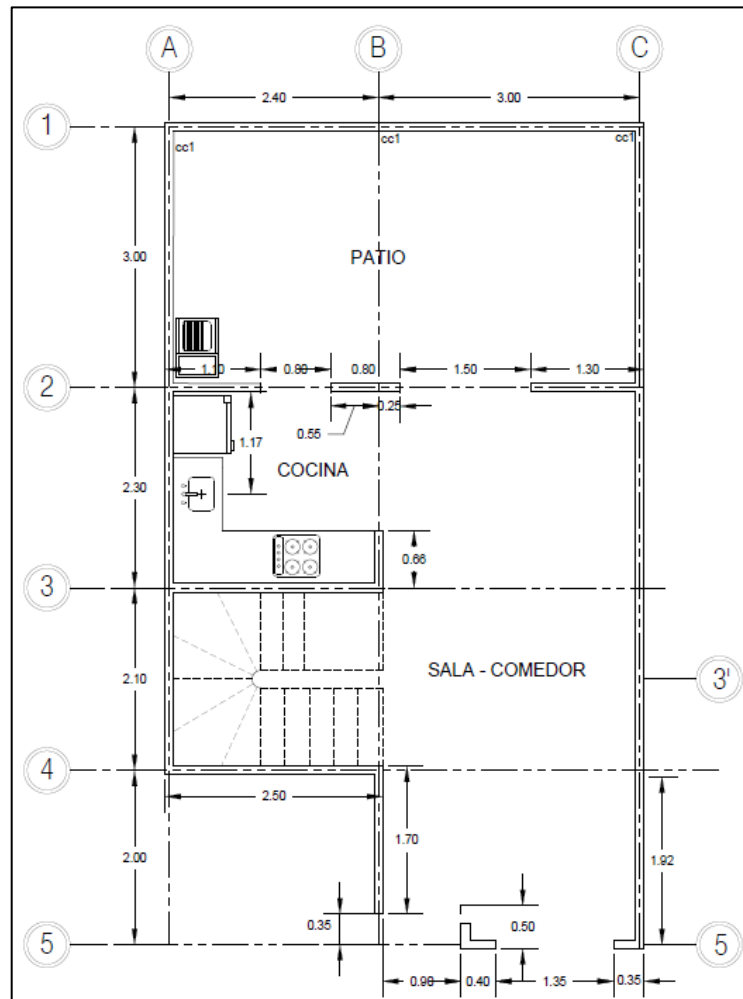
Planta arquitectónica primer piso. Fuente: Propia
